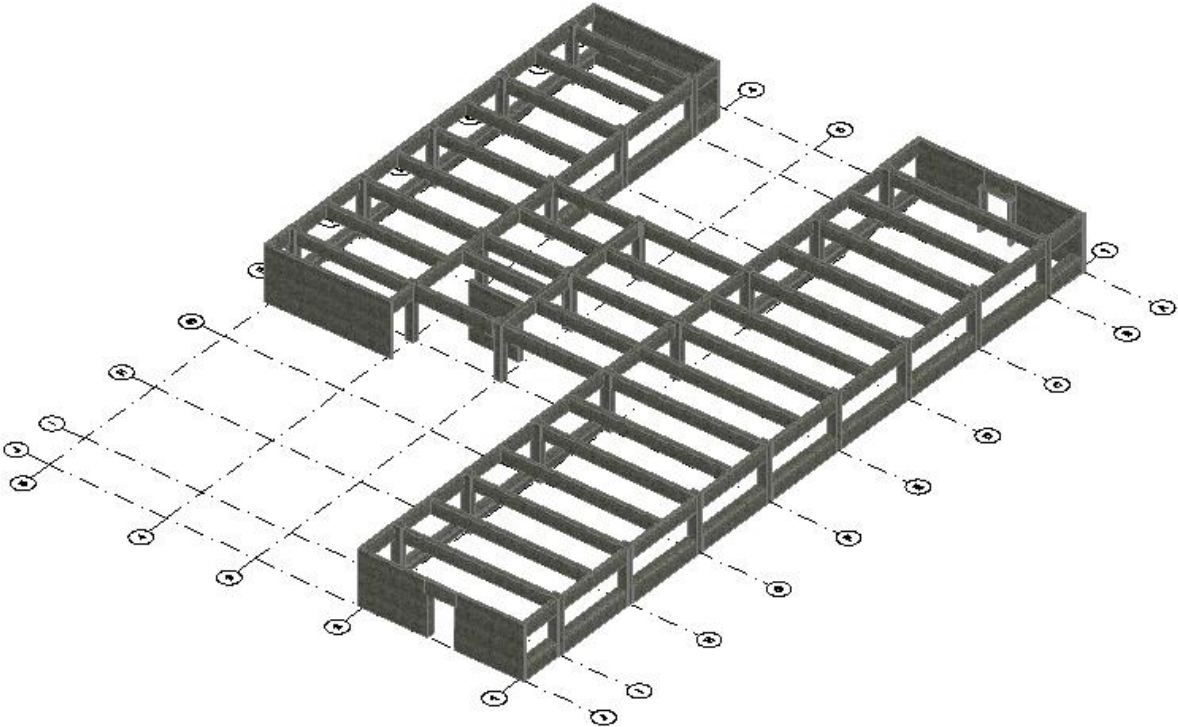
Vista en 3D, en Planta del Nivel 1
